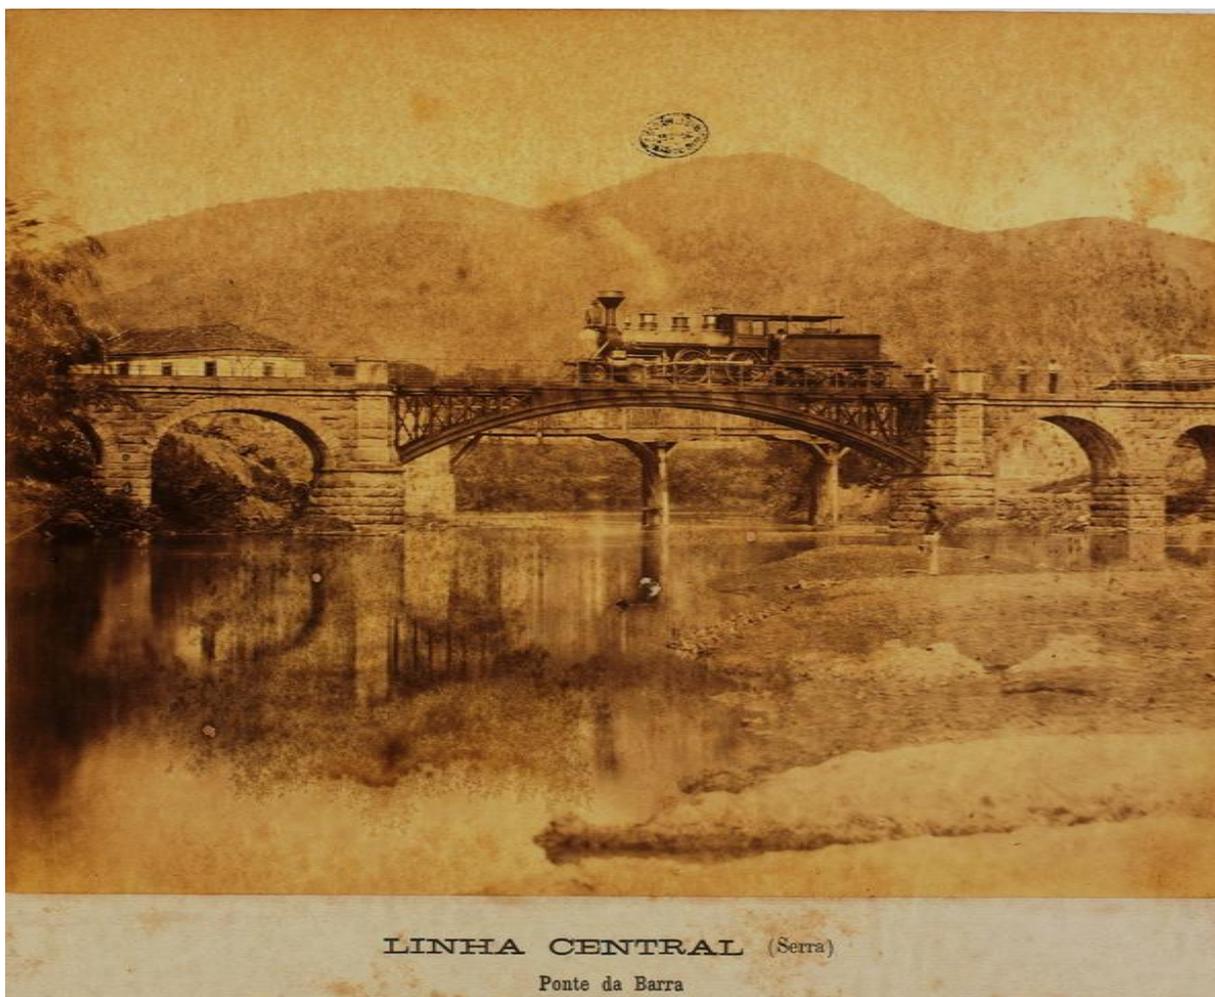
Estrada de Ferro D. Pedro II: Linha Central, serra: estação da Barra do Pirahy; kilometro 108,080. Acervo: Biblioteca Nacional. Collecção de 44 vistas photographicas da Estrada de Ferro D. Pedro 2. Foto 14
